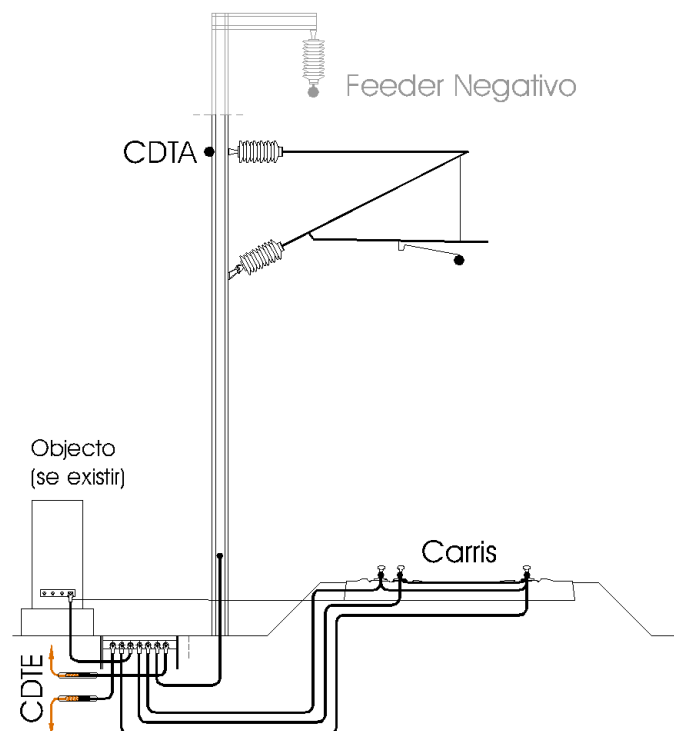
LTI para via única a 3 carris; desenho de princípio; Sistema AT
